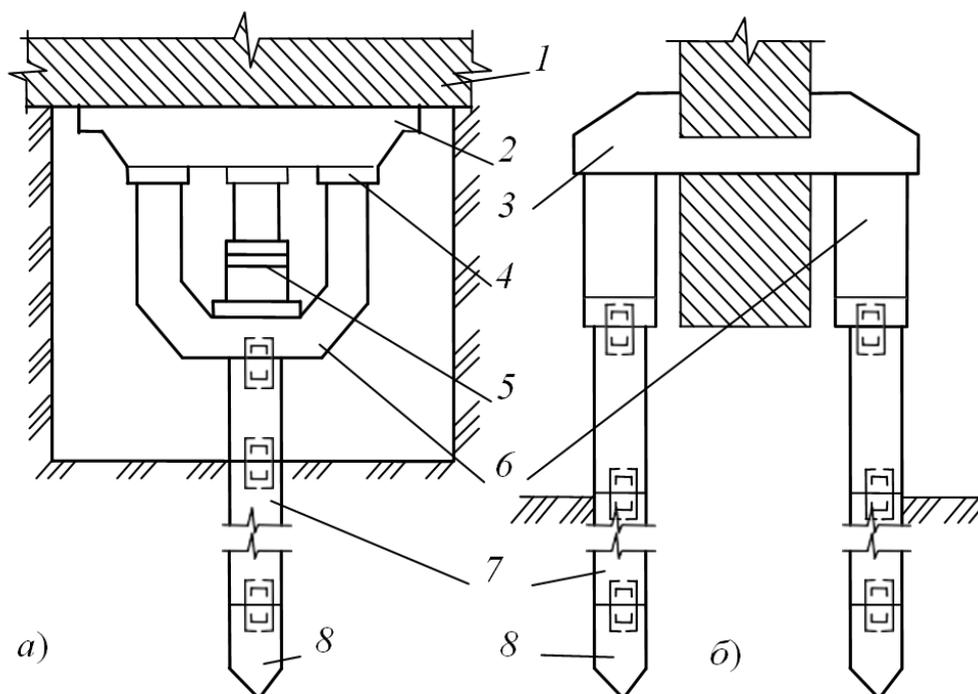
Варианты усиления фундаментов железобетонными вдавливаемыми сваями: 1 – фундамент; 2 – распределительный элемент; 3 – железобетонная балка; 4 – клинья; 5 – домкрат; 6, 7, 8 – соответственно головная, рядовая и нижняя секции свай
